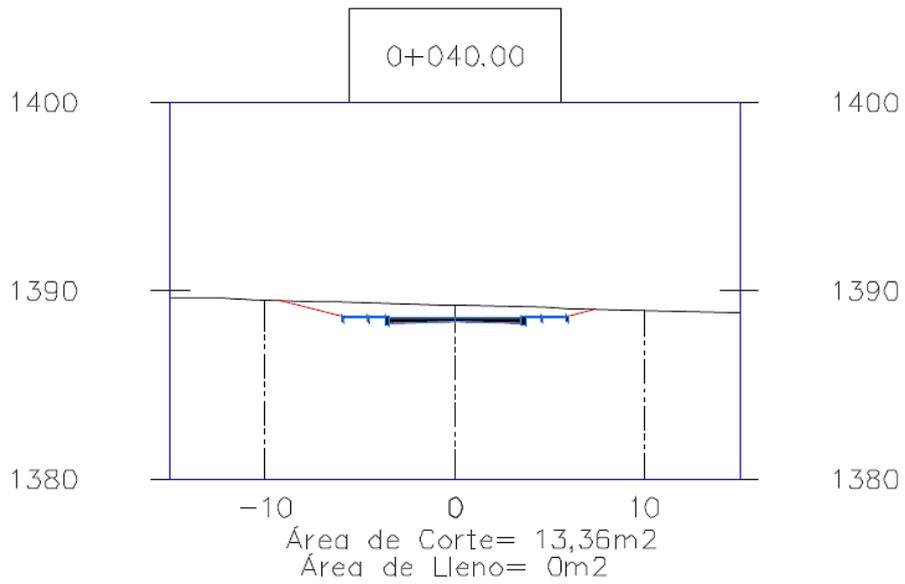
Sección Transversal, abscisa 0+040. Elaboración Propia
